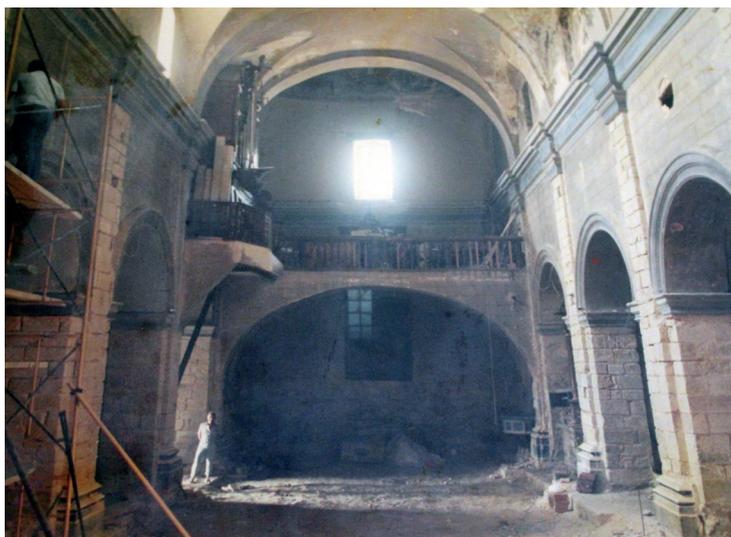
Fotografía de la restauración donde se descubrió la cimentación.
